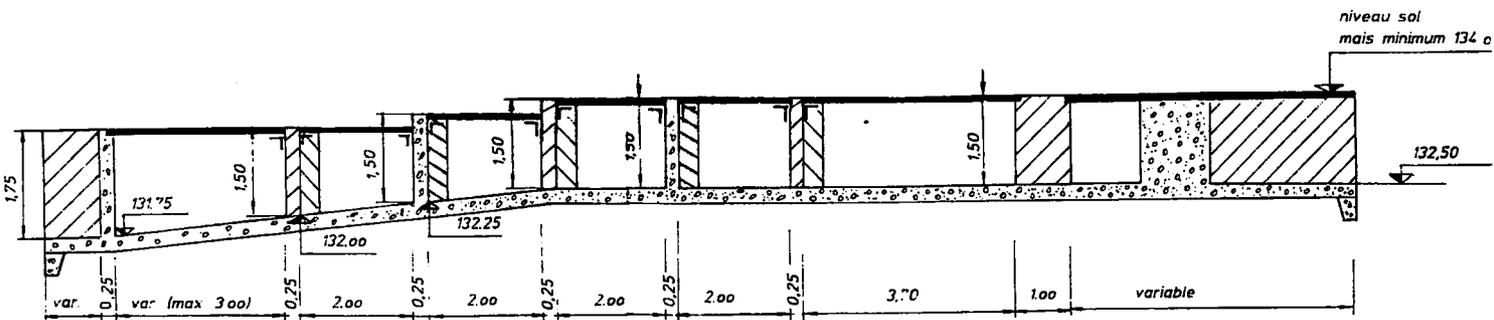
/4. Plans de l'échelle à poissons du barrage de Bomal sur l'Aisne (source: Division de l'Eau, Centre de Marche-en-Famenne, Secteur de Houffalize).
